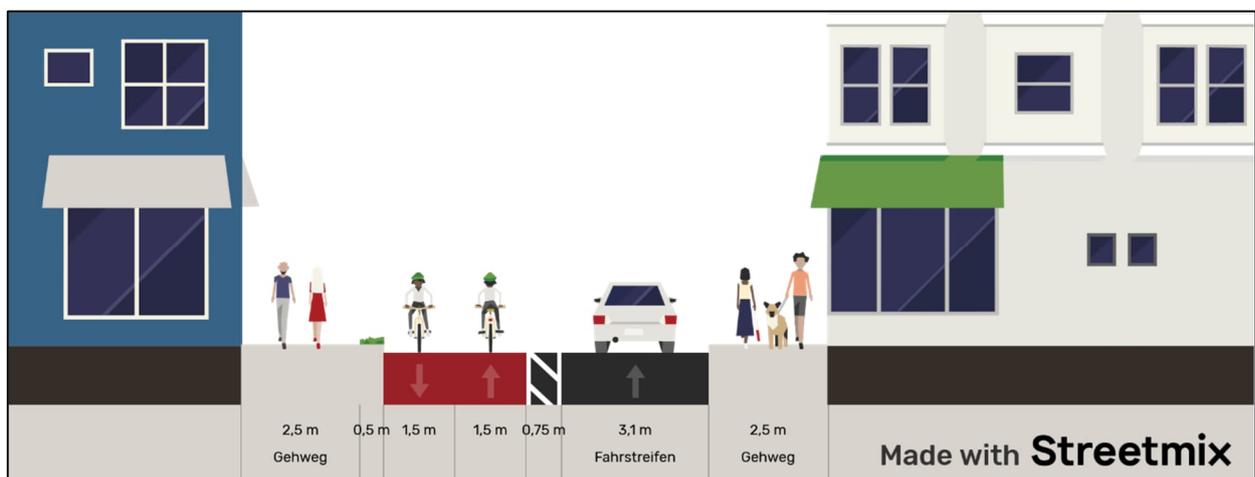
Straßenquerschnitt Wilhelmstraße – Einbahnstraßenring – Blickrichtung Westen
